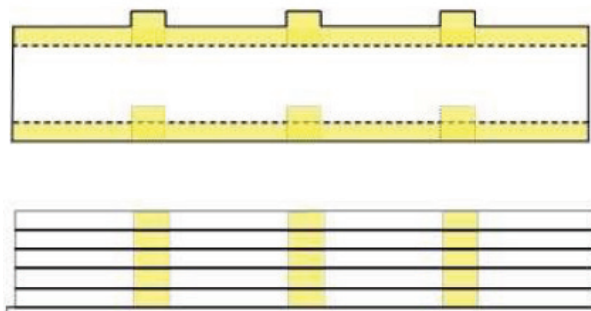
, 79: Grundriss, Schnitt, M ca. 1 : 2.000
